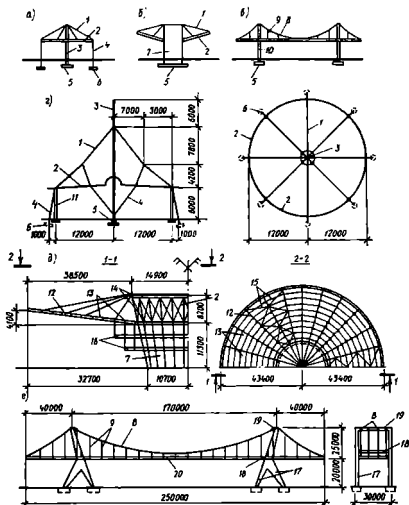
Подвешенные на вантах жесткие покрытия:
